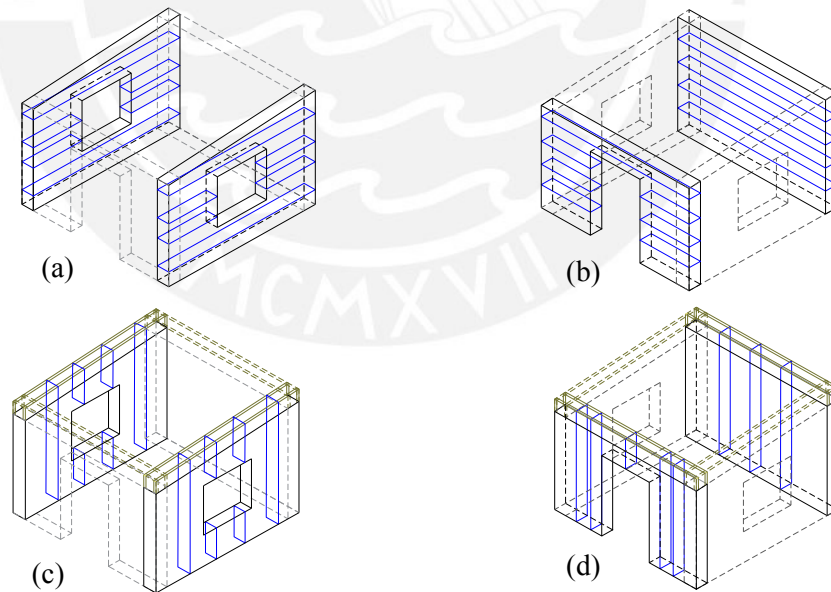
Esquemas de refuerzo con malla de drizas: (a) refuerzo horizontal en muros laterales, (b) refuerzo horizontal en muros transversales, (c) refuerzo vertical en muros laterales y (d) refuerzo vertical en muros transversales
